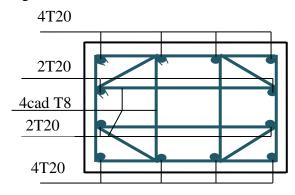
Ferraillage des poteaux des Sous-sol (70x70).
